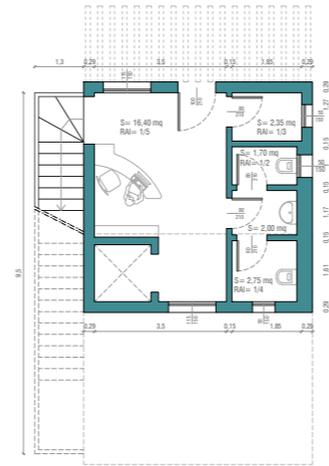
Pianta piano terra. Scala 1:200
